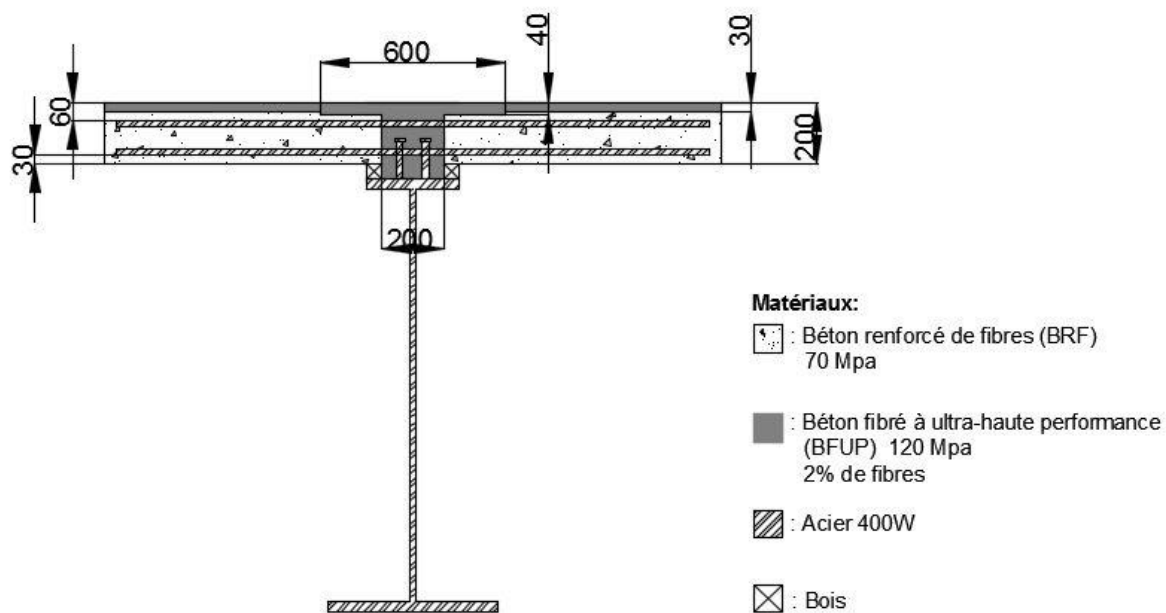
Configuration optimale du joint longitudinal au droit de la poutre avec des dalles hybrides et de grandes ailes au niveau du joint
